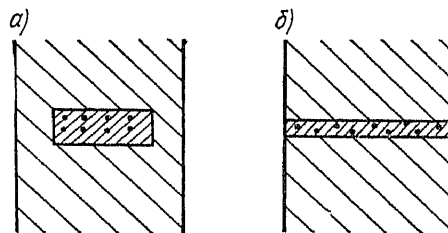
Размещение железобетонных поясов (а) и армированных швов (б) в стенах здания
